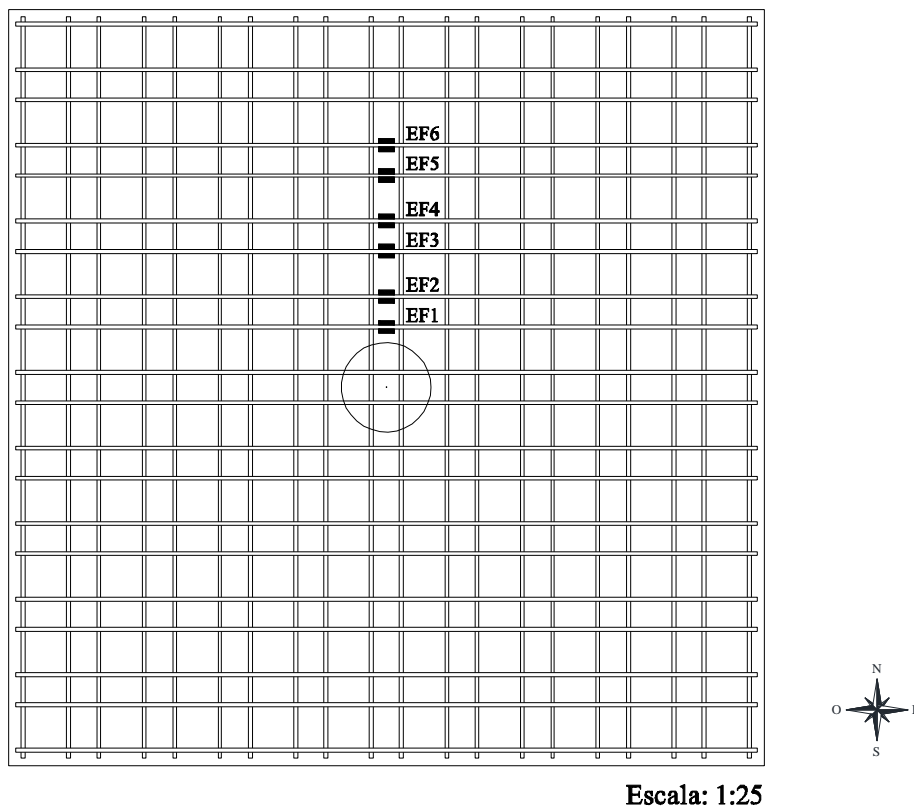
Posição dos extensômetros das armaduras de flexão (EF) – vista em planta
